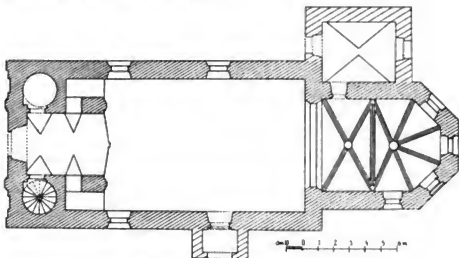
Újezd Drahoňův. Grundriss der Kirche.
